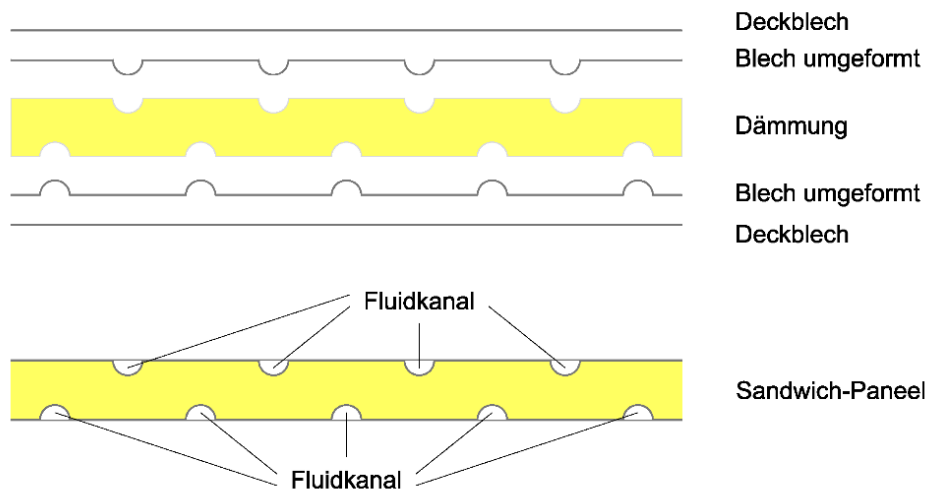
Aufbau Sandwichpaneel (vier Bleche) [14]
